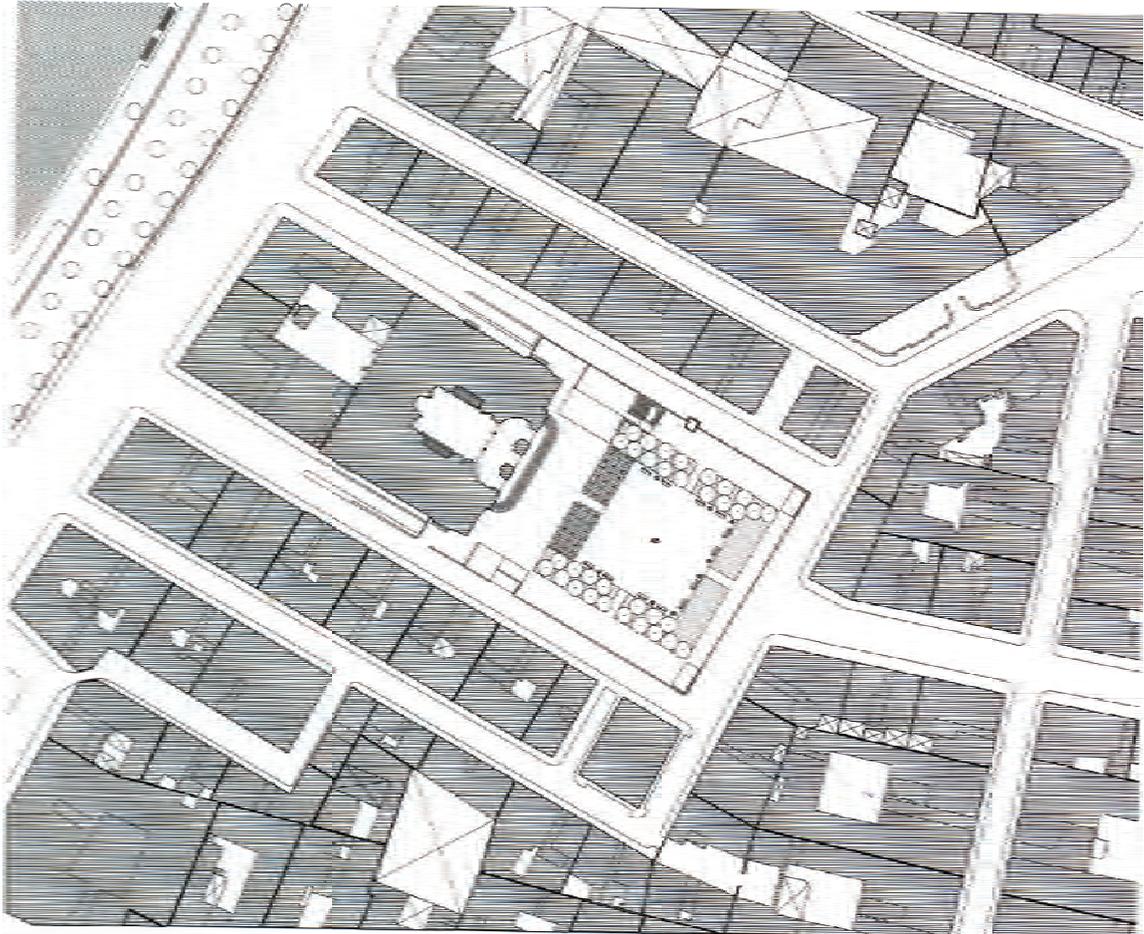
Place des Célestins mit Umgebung, Lageplan
